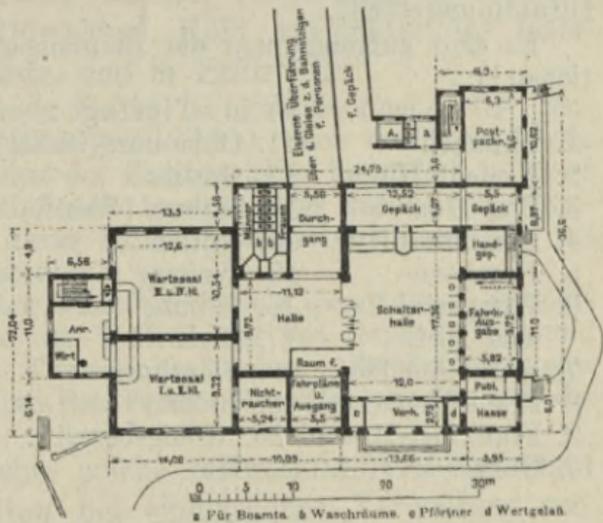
Grundriß des Empfangsgebäudes Solingen. M. 1 : 1200.
